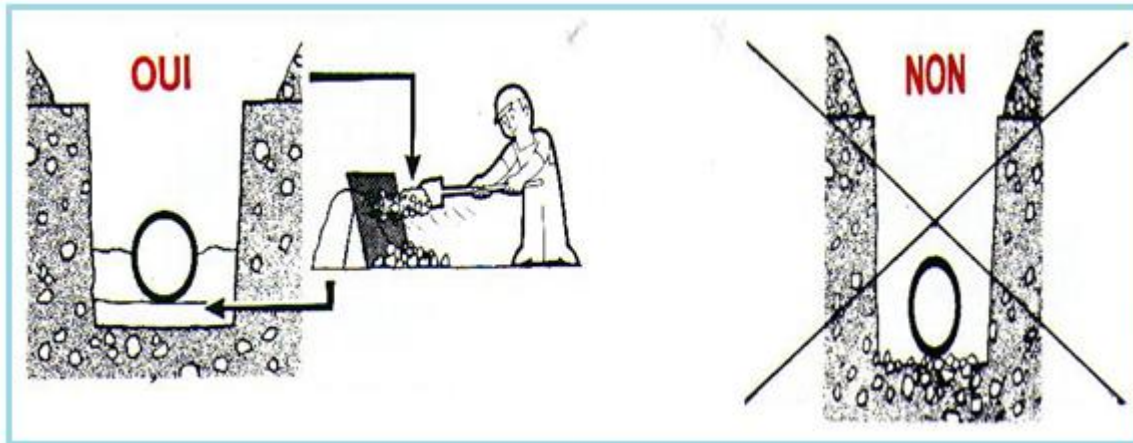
REMBLAIEMENT DES TRANCHEES
